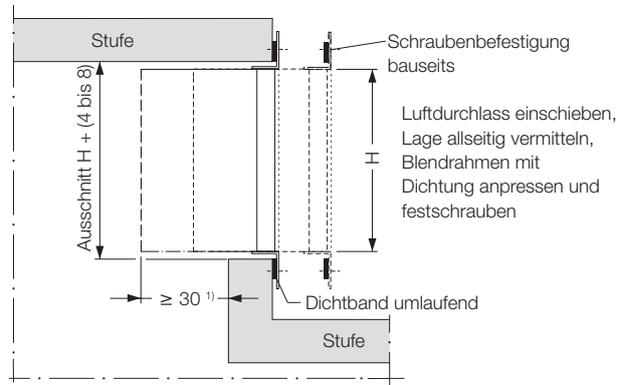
Ausführung mit Blendrahmen für Schraubenbefestigung
